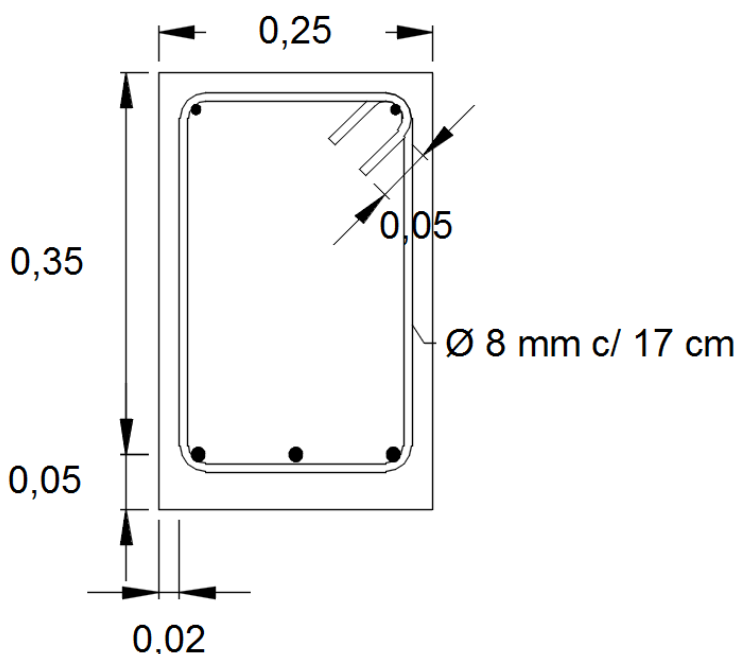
Armadura transversal de la viga V3 del bloque 1.
